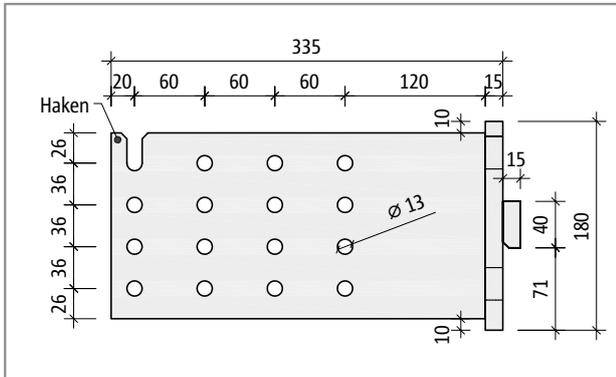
Schöck Isokorb® T Typ SQ mit Stahlschwert: Stahlschwert
